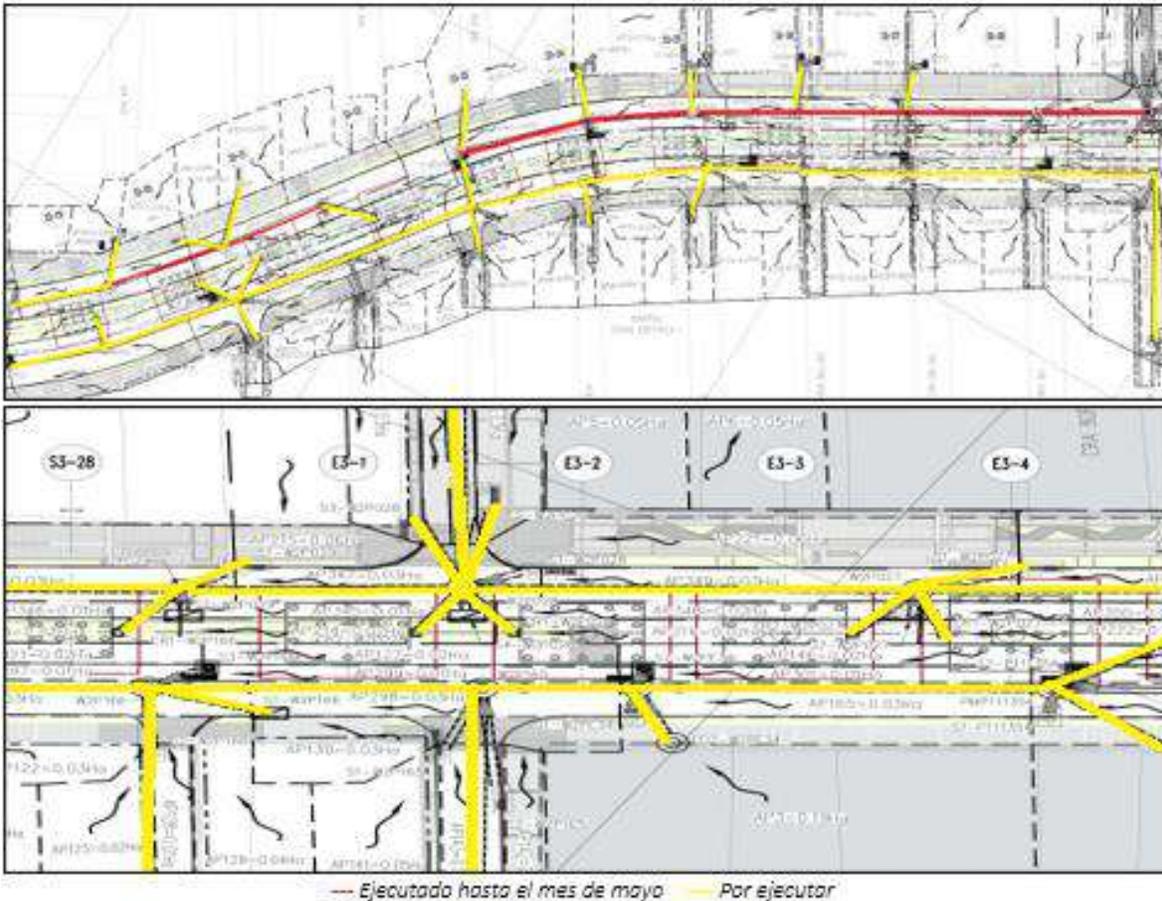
Plano de localización ejecutado y por ejecutar red alcantarillado pluvial PLU2-05
